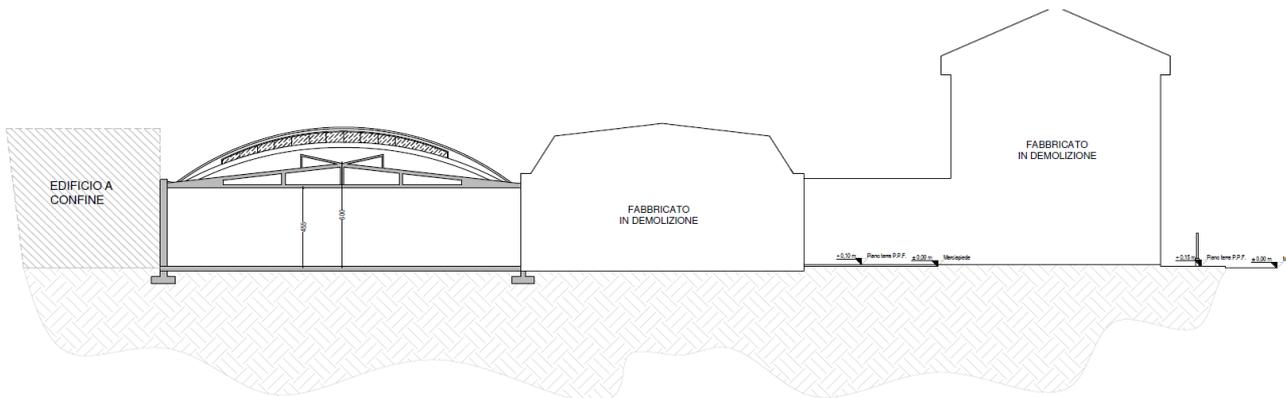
sezione b-b' stato di fatto dei fabbricati conservati
